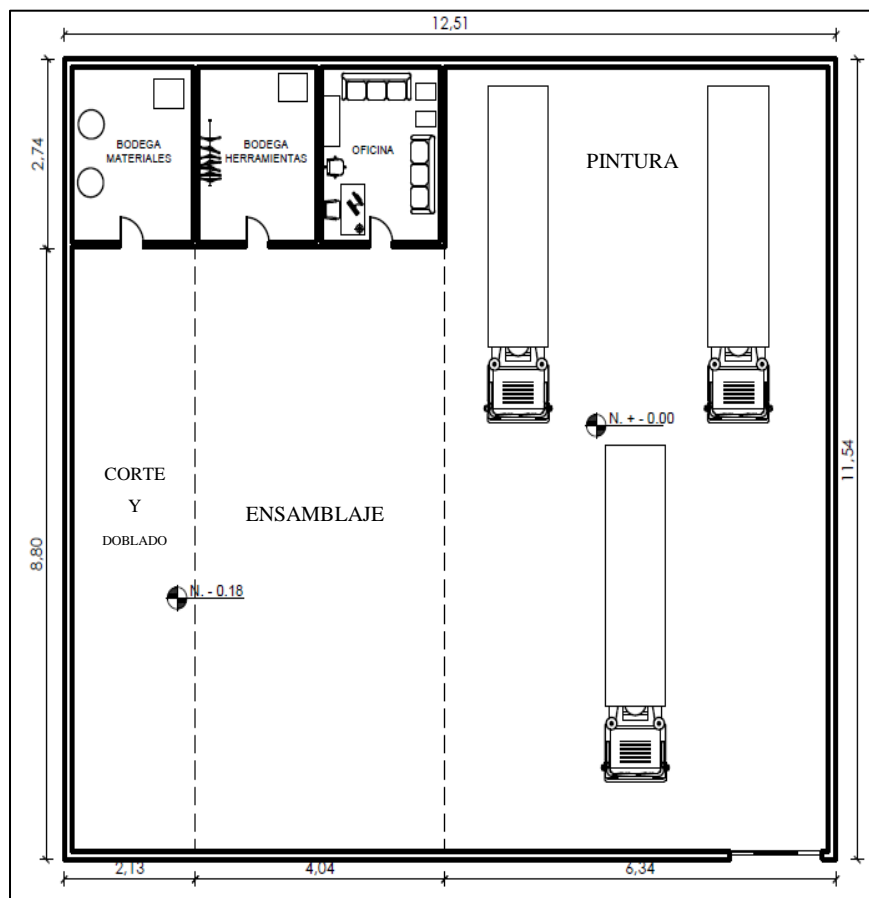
Planimetría Fábrica de Carrocerías Master Metal
